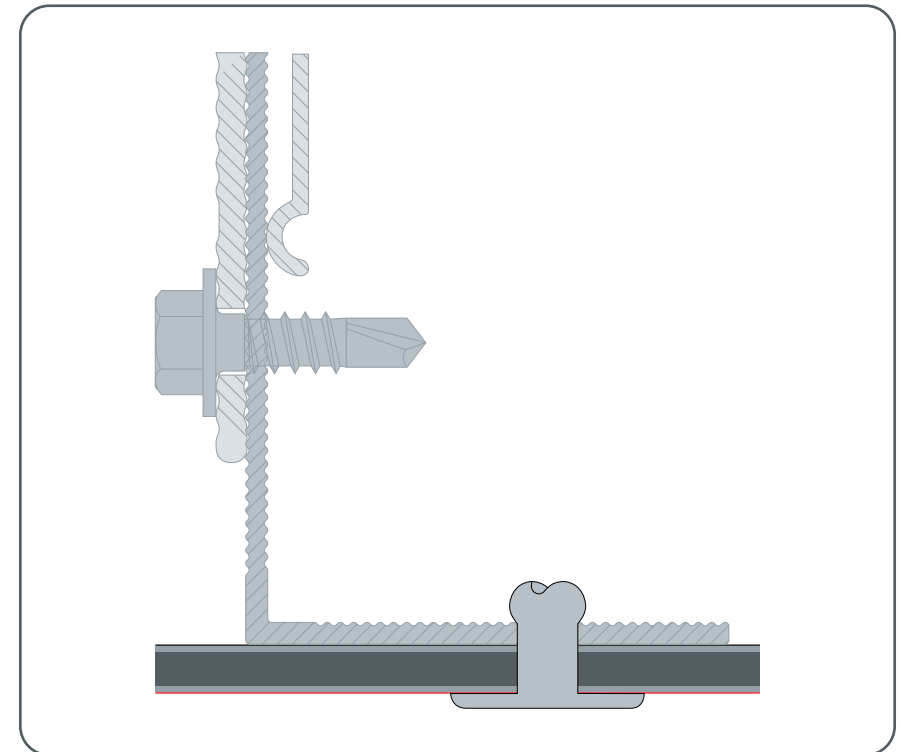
· Point fixe sur sous-construction métallique ($\varnothing 5,1$ mm ; sans douille de guidage pour point fixe)
